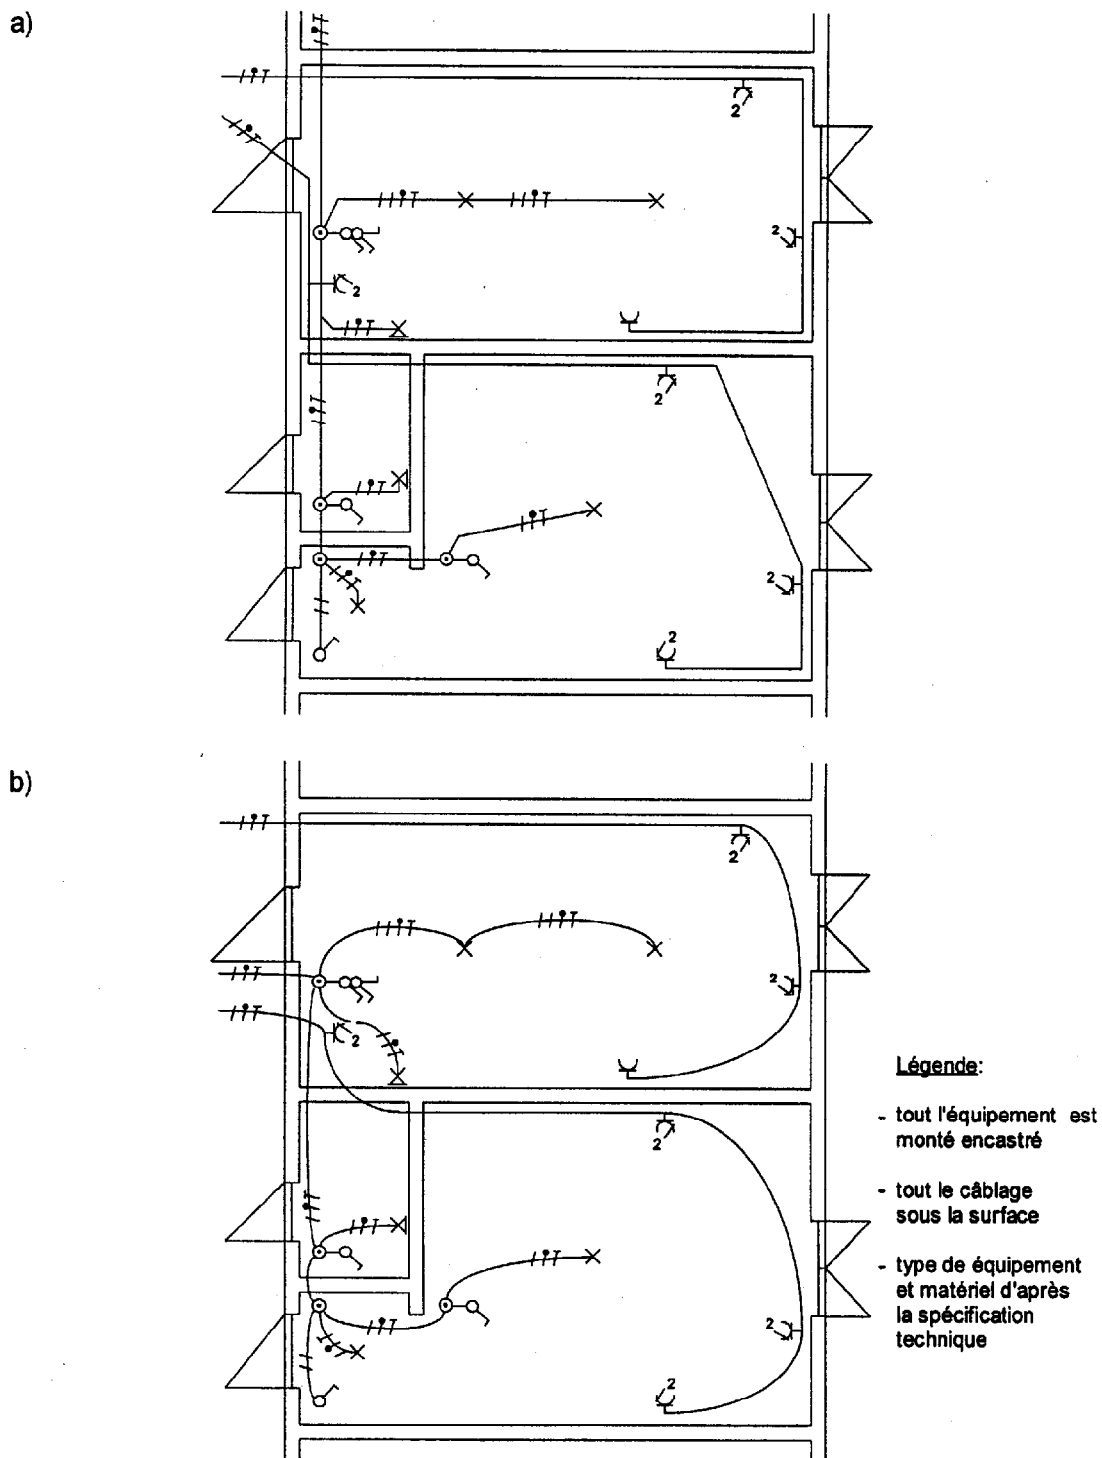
Exemples de schéma d'installation d'un bâtiment (deux méthodes différentes): installation d'alimentation électrique dans un bâtiment résidentiel (voir 5.3.2)
